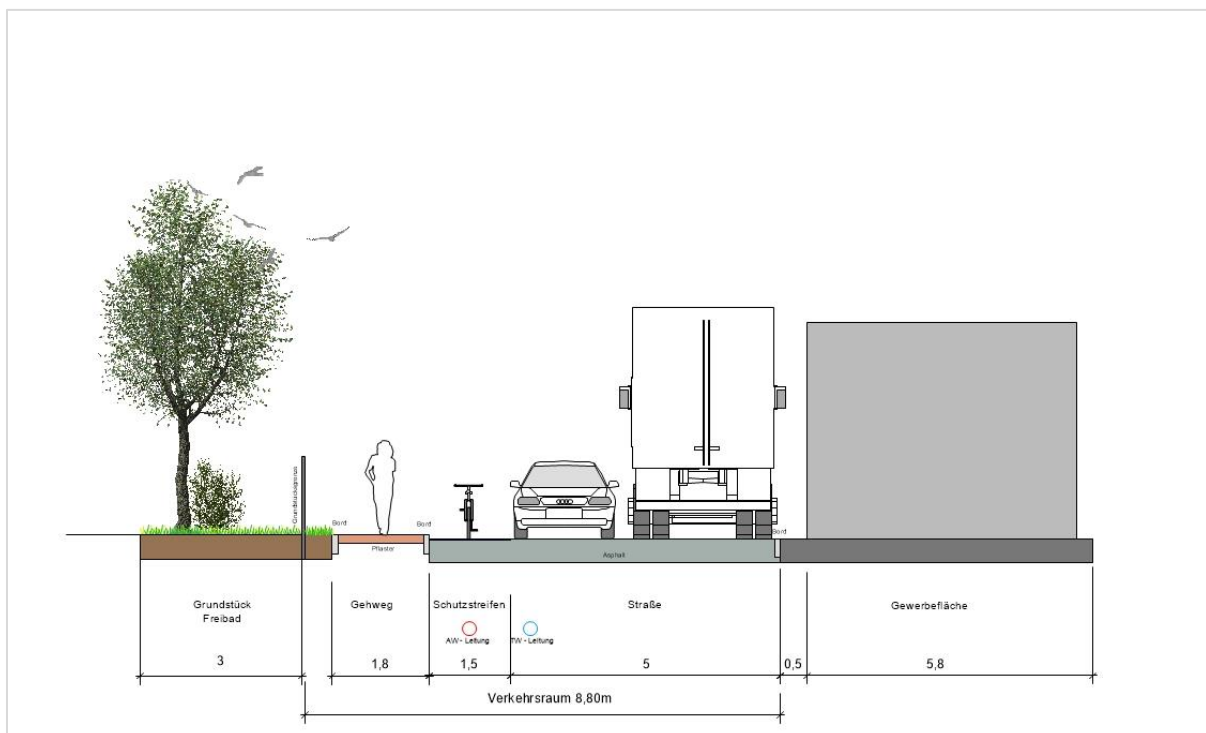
Schnitt neue öffentliche Verkehrsfläche im östlichen Plangebiet
